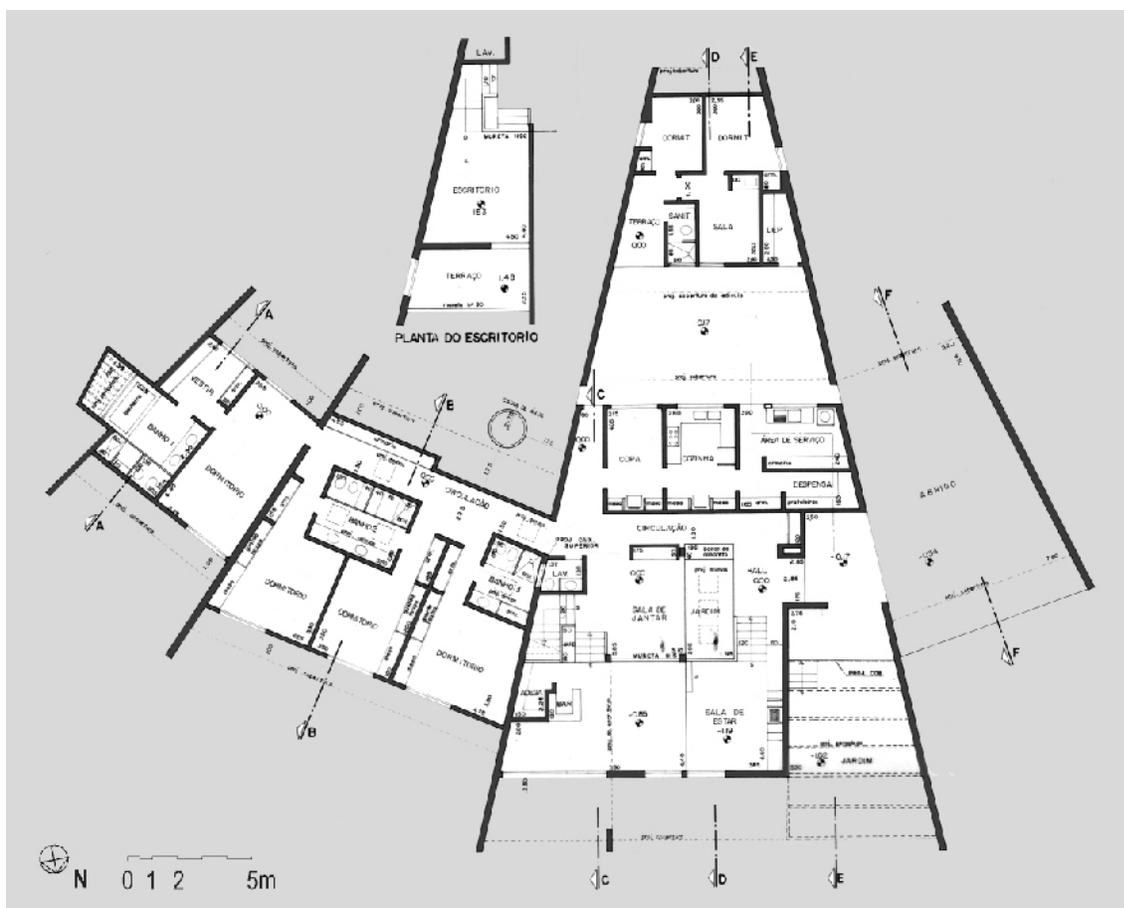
Segundo estudo de caso: planta do pavimento e mezanino.
